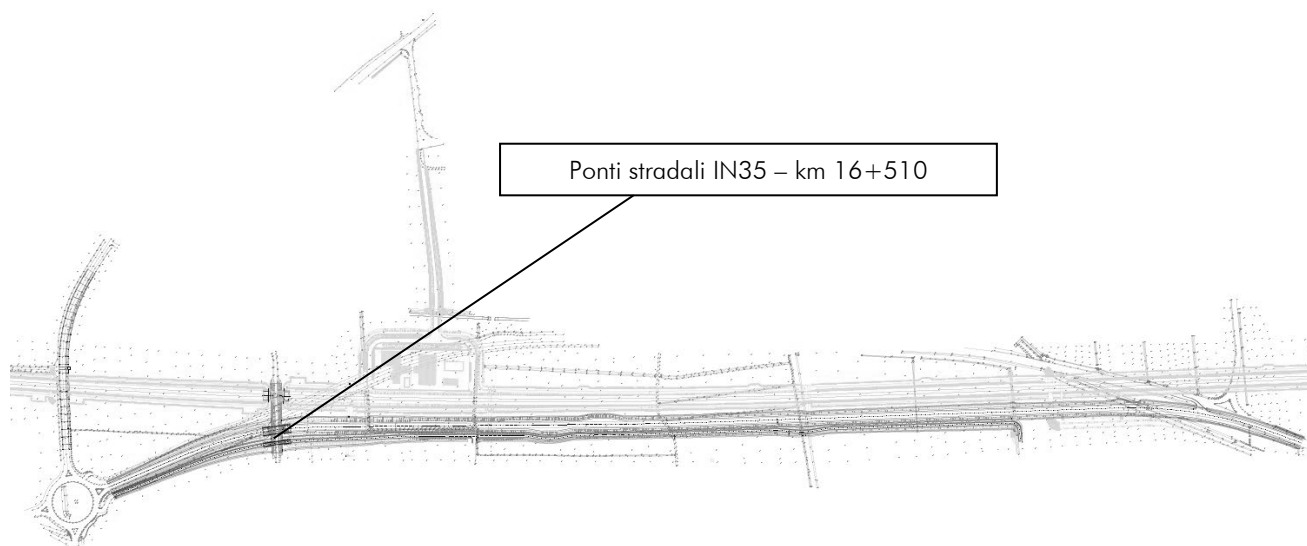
Stralcio planimetrico – Ubicazione Ponti IN35
